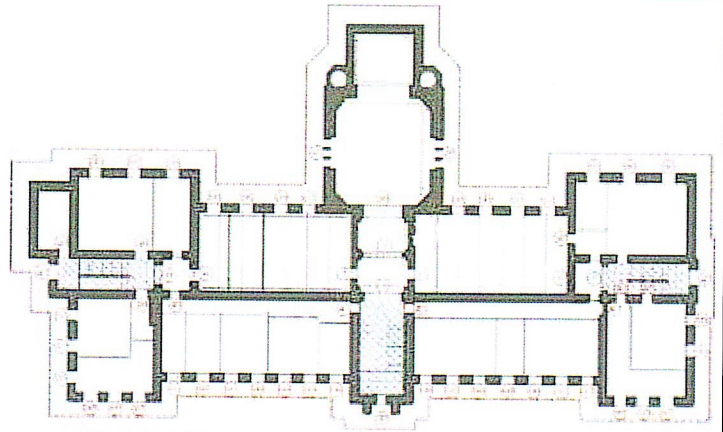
План второго этажа с указанием помещений. Оформление потолка
